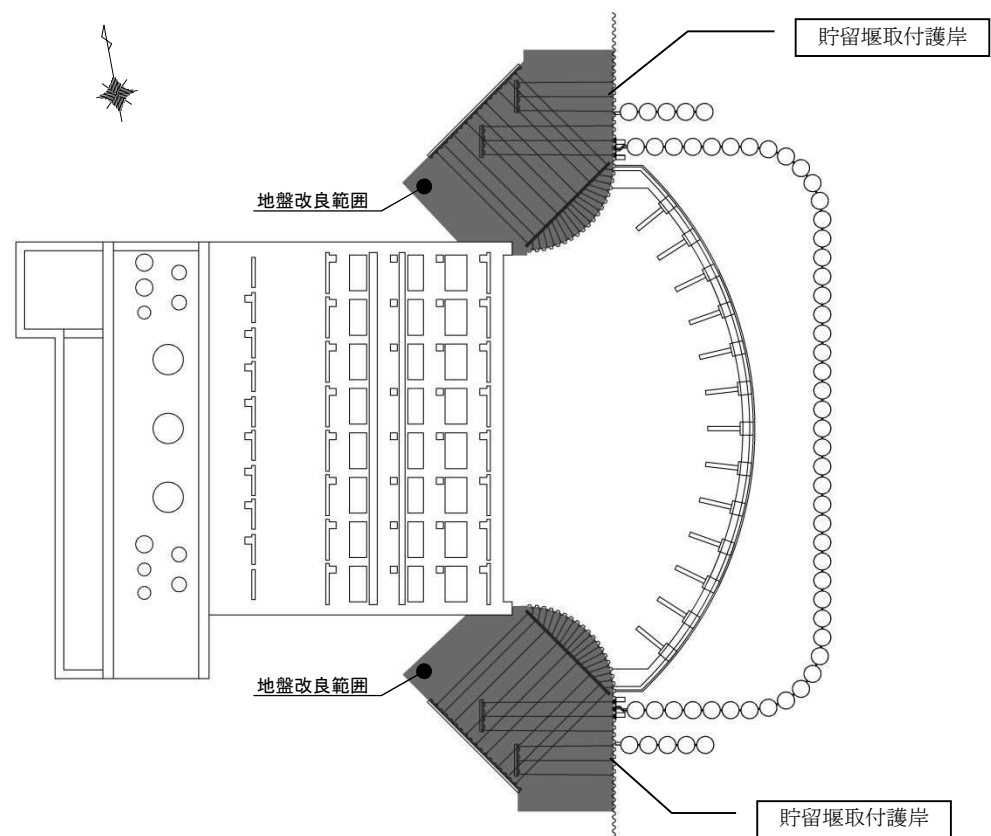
(2) 貯留堰取付護岸の平面配置図（拡大図）
